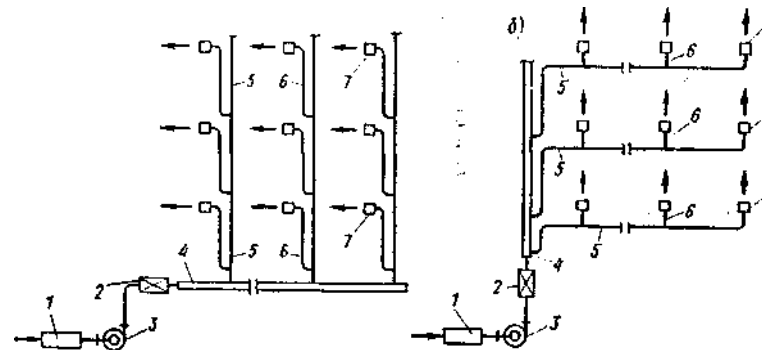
Схемы высокоскоростных систем центрального воздушного отопления зданий.
